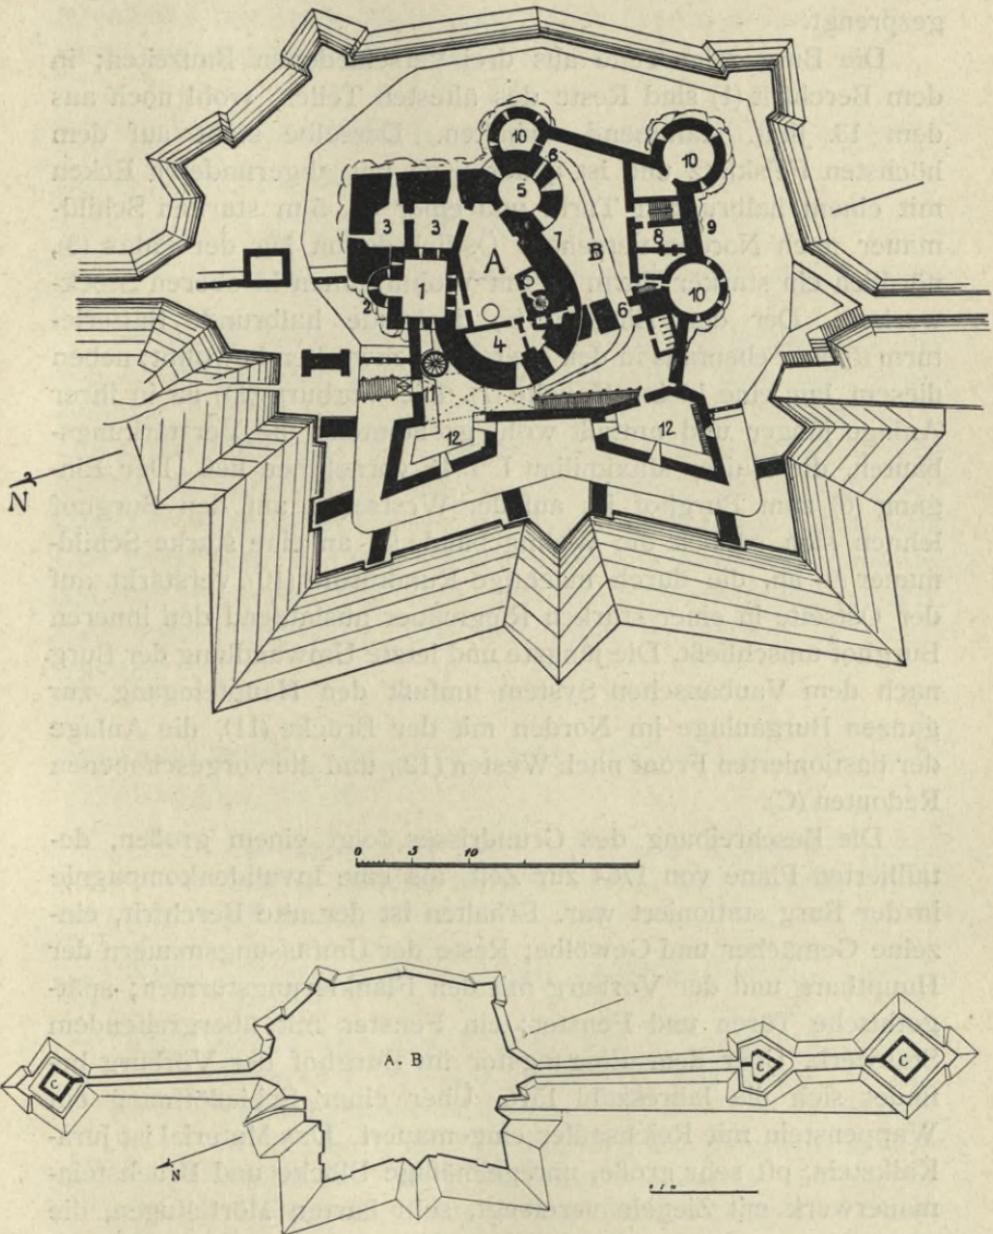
und 32. Landskron, Grundriß und Lageplan
